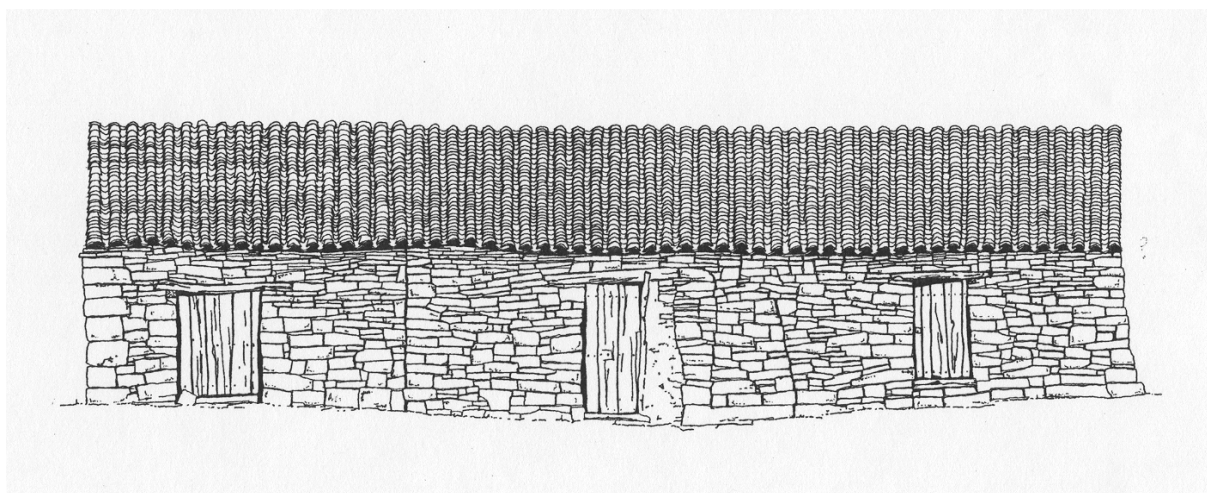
Parideras en Herrería (Guadalajara). Alzado sur
